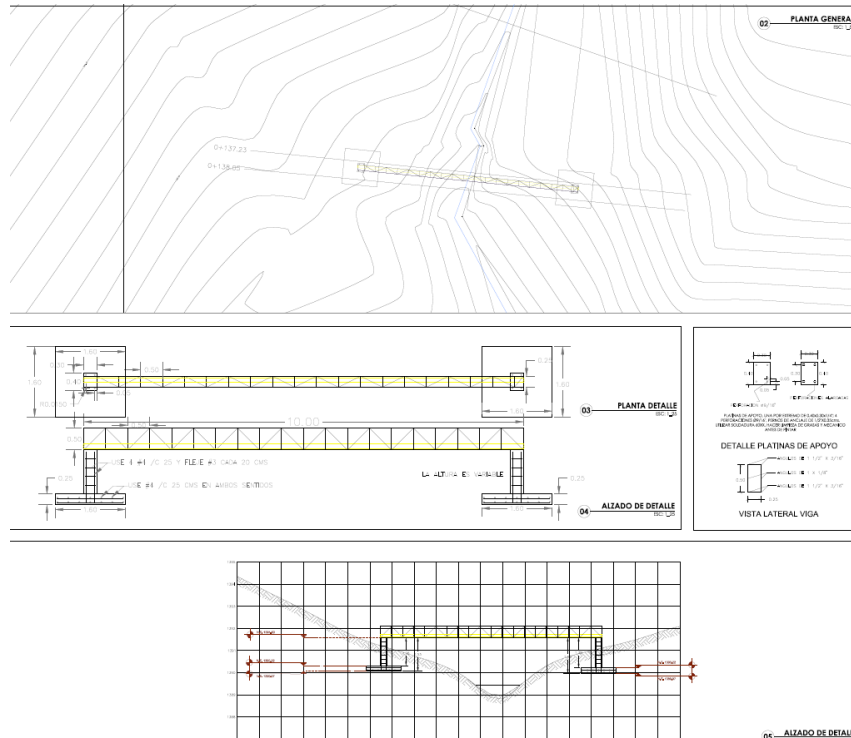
Esquema de obra Hidráulica Propuesta (recalce estructural de los estribos).
